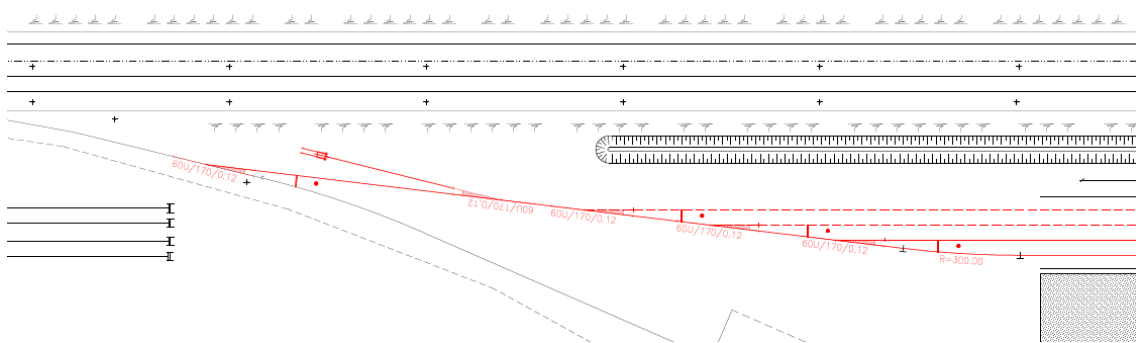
Estratto della Planimetria di Progetto: Asta di raccordo alla rete esistente
